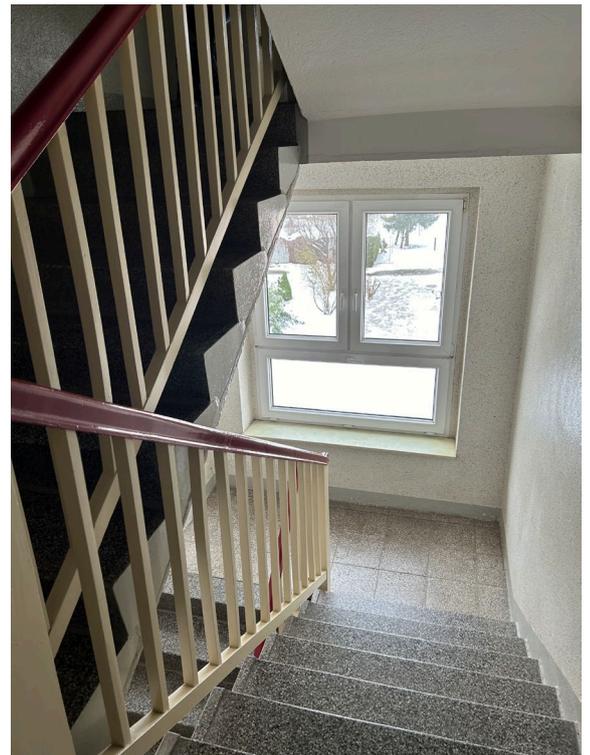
Teilansicht Treppenhaus Haus Nr. 37
